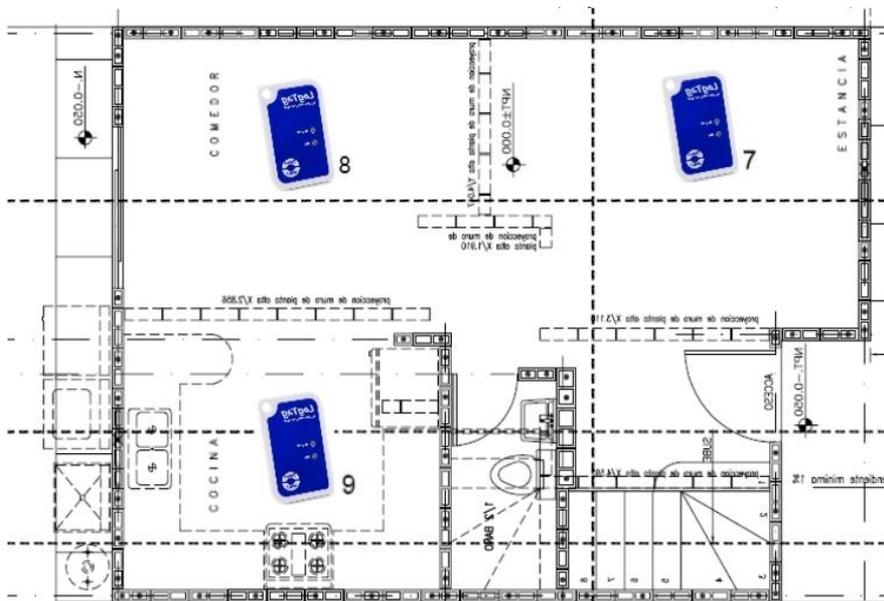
Planta arquitectónica de la vivienda dos, primer nivel. Orientada al Oeste
